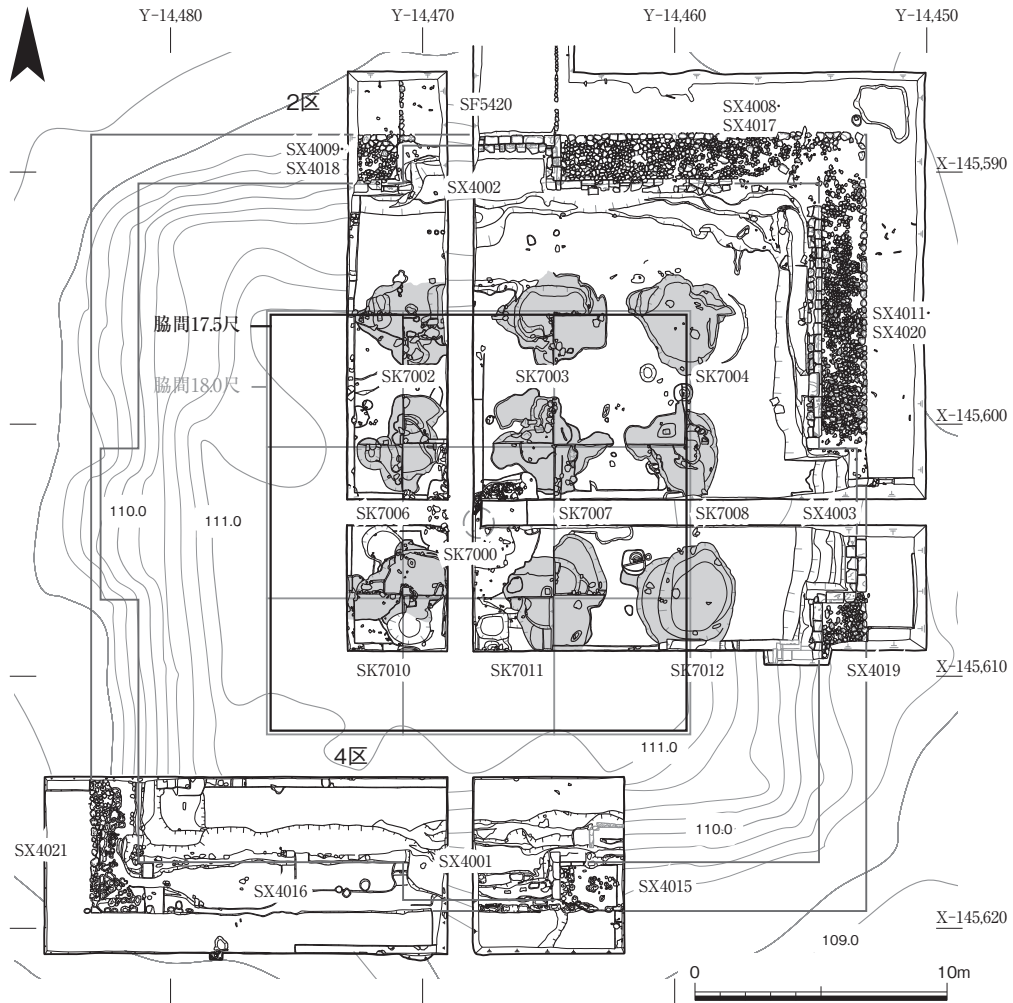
栄西案 初重平面の再検討 1 : 300
